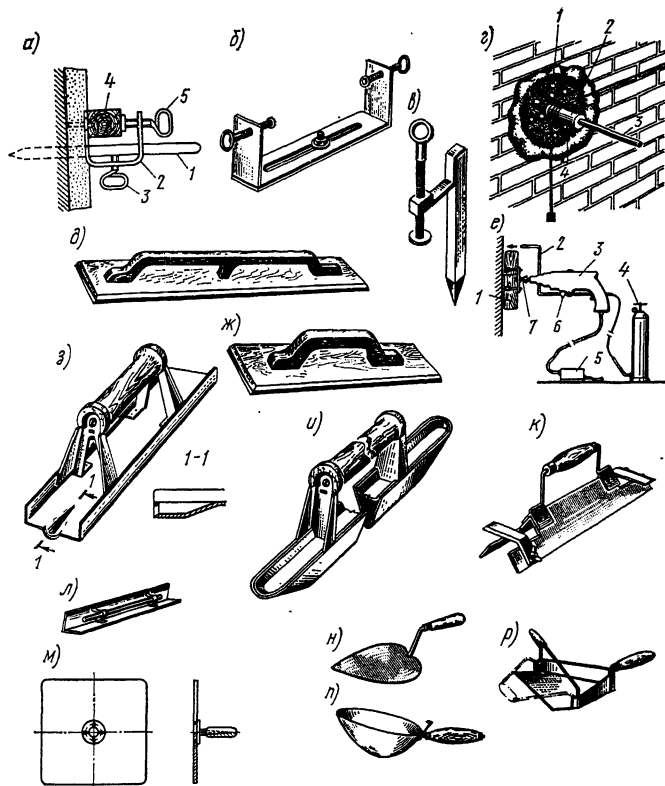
Приспособления и инструменты для устройства монолитной штукатурки
